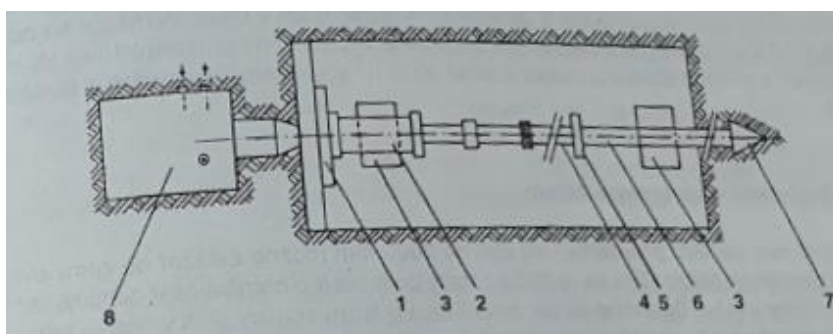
Priemer potrubia pre metódy neriadeného mikrotunelovania [3]
